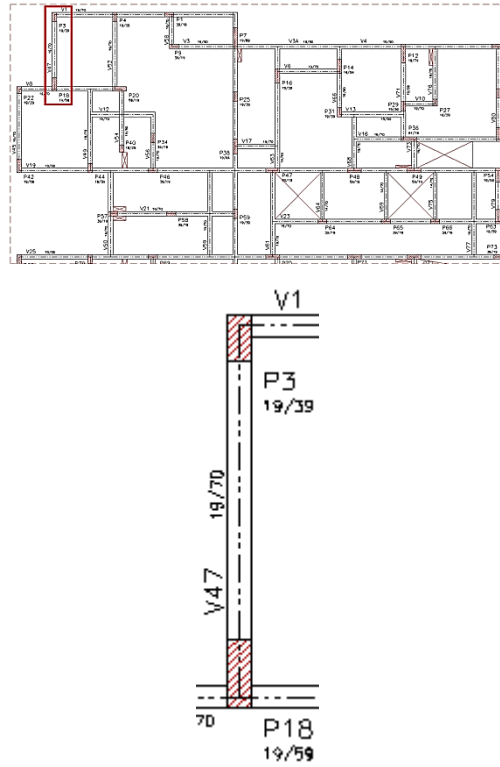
Edifício Vita Belle: localização da viga V47
